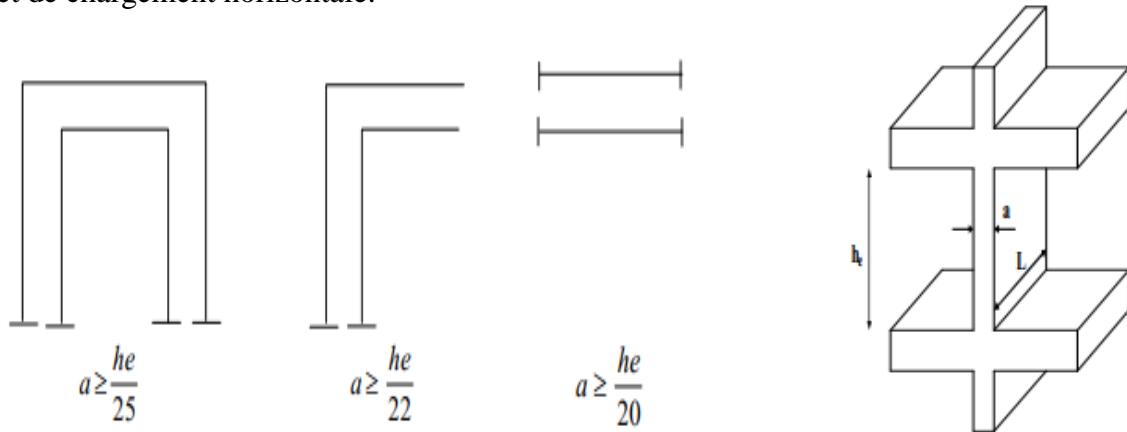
coupe des voiles en plan et coupe de voile en élévation.
